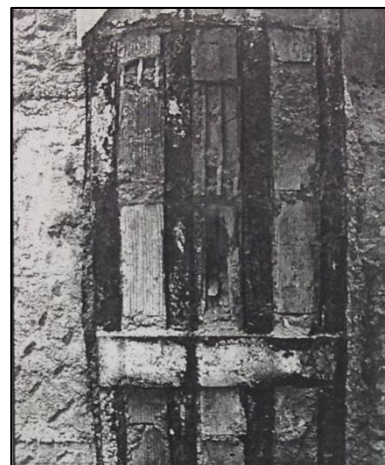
Refuerzo de estructura metálica en pilares de mampostería
